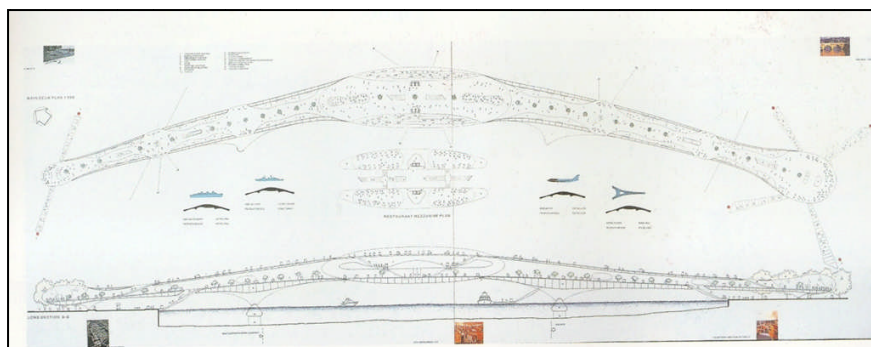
, Future Systems, *The People's Bridge*: secção longitudinal, 1996.
